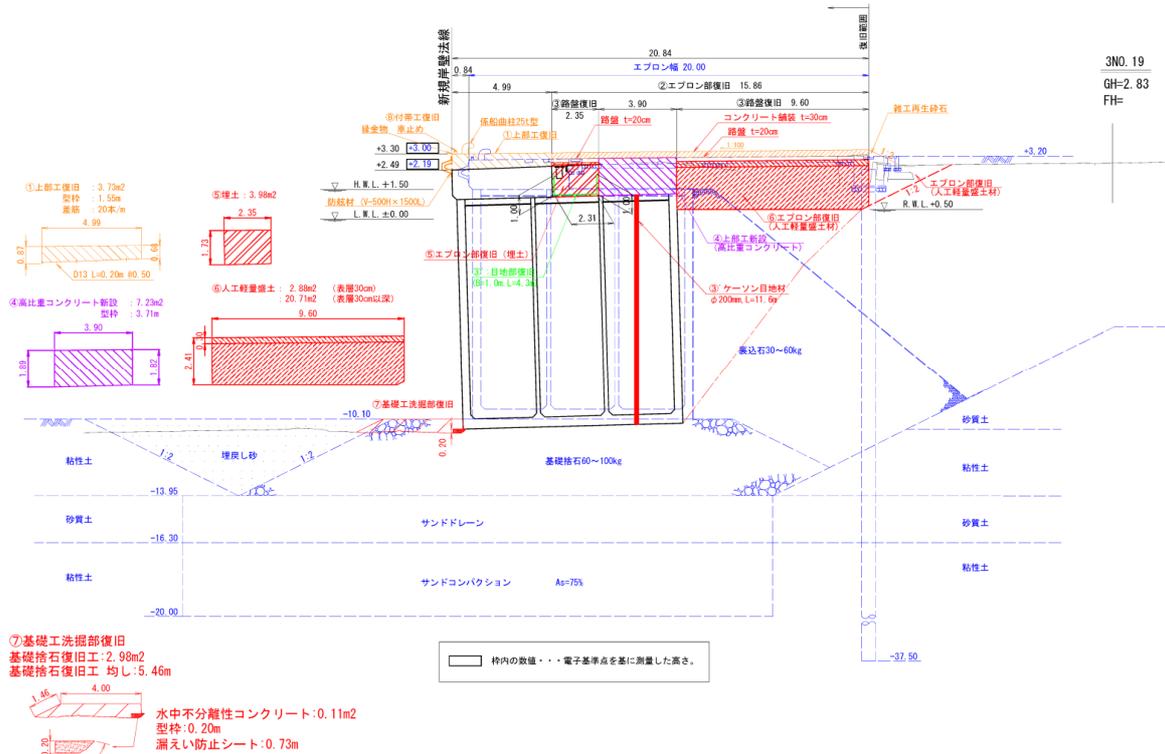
No.10 日立港区_第4ふ頭地区 4-D岸壁 (-10.0m) の断面図 No.2 (復旧後)
